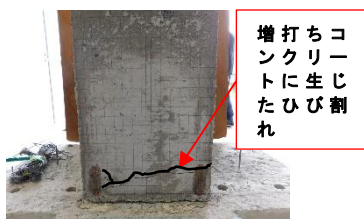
増打ちコンクリートのひび割れ (PP2-E)
